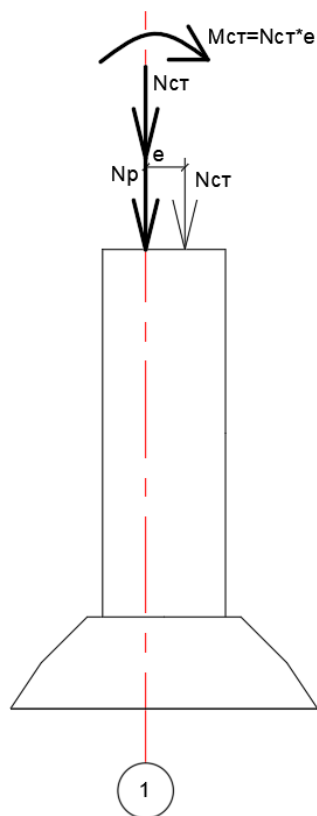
Нагрузки, действующие на фундамент в осях 1/Б-В
